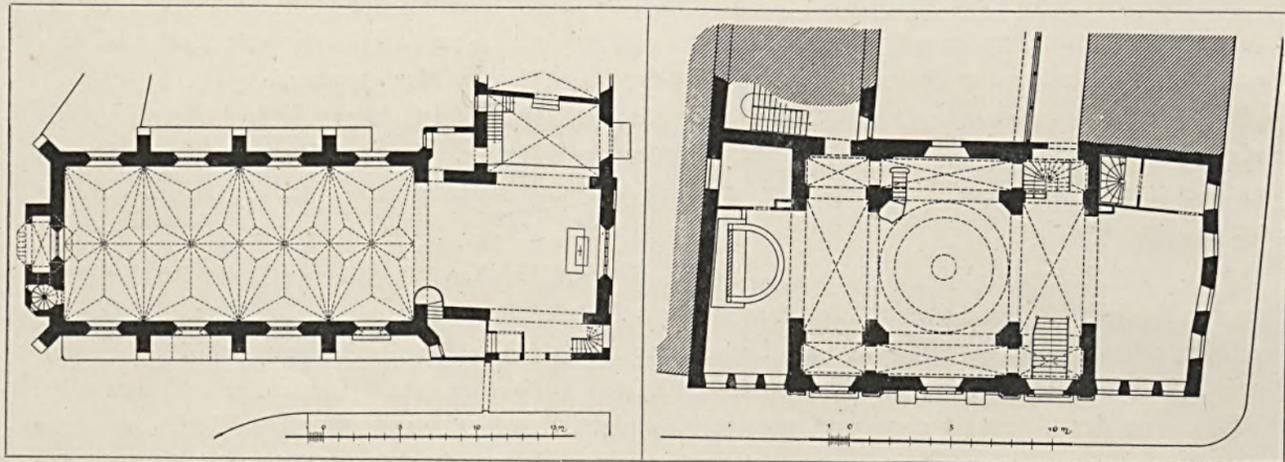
Elisabethkirche. Grundriss. (G.)
